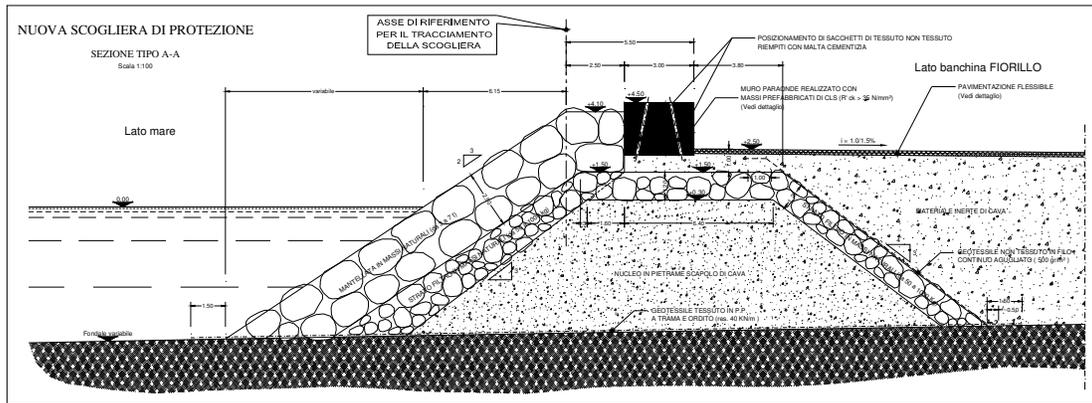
Sezione tipo della nuova scogliera di protezione del molo di levante
